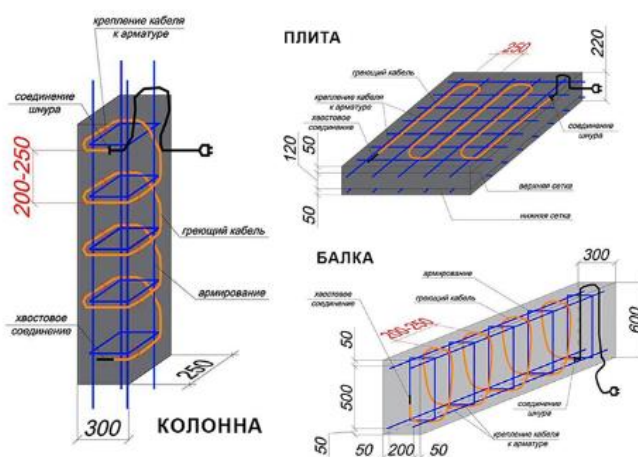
Схема раскладки греющего кабеля КДБС [3]
